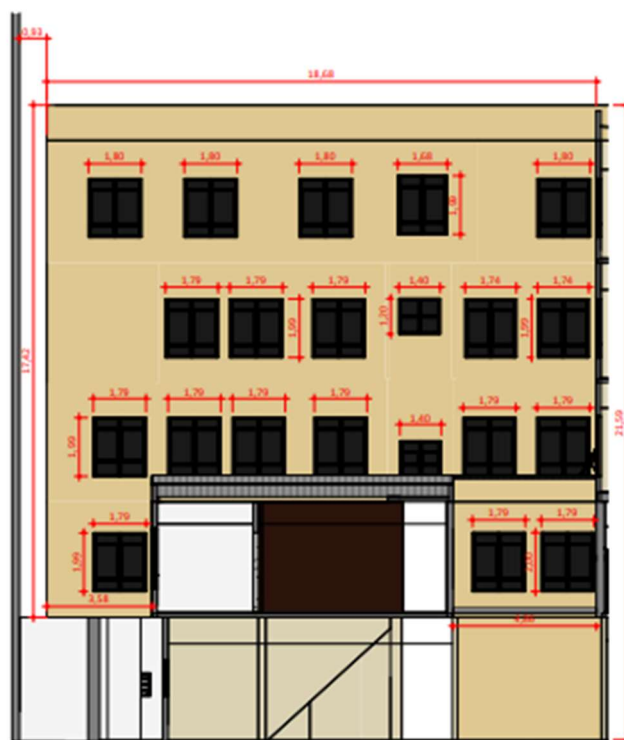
Elevação - Fachada Fundos - Vista Oeste - TJMSP
